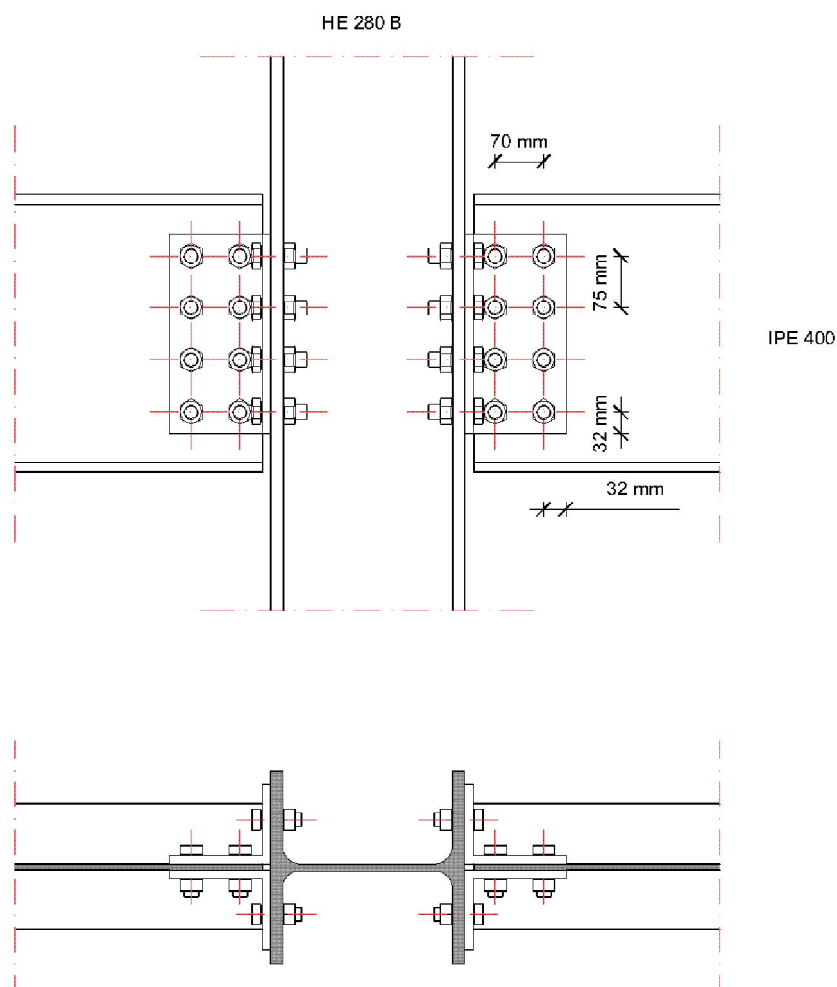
rappresentazione del nodo imbullonato (cerniera) di connessione trave pilastro per la soluzione travi miste incernierate e solaio continuo
